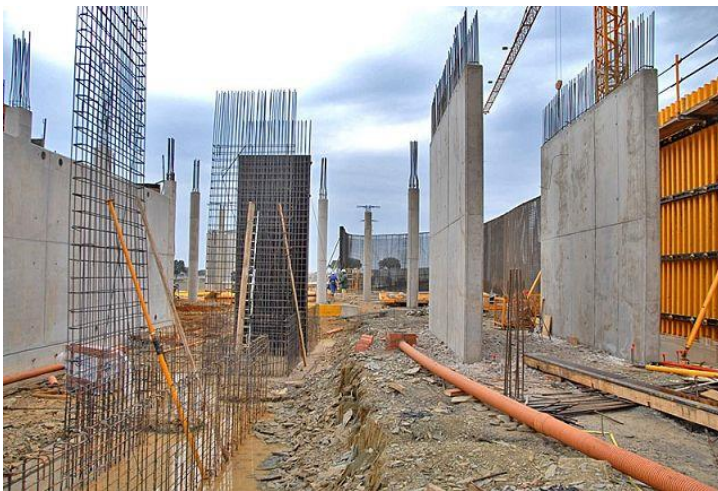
Construcción con muros pantalla. Fuente: Construmatica.
